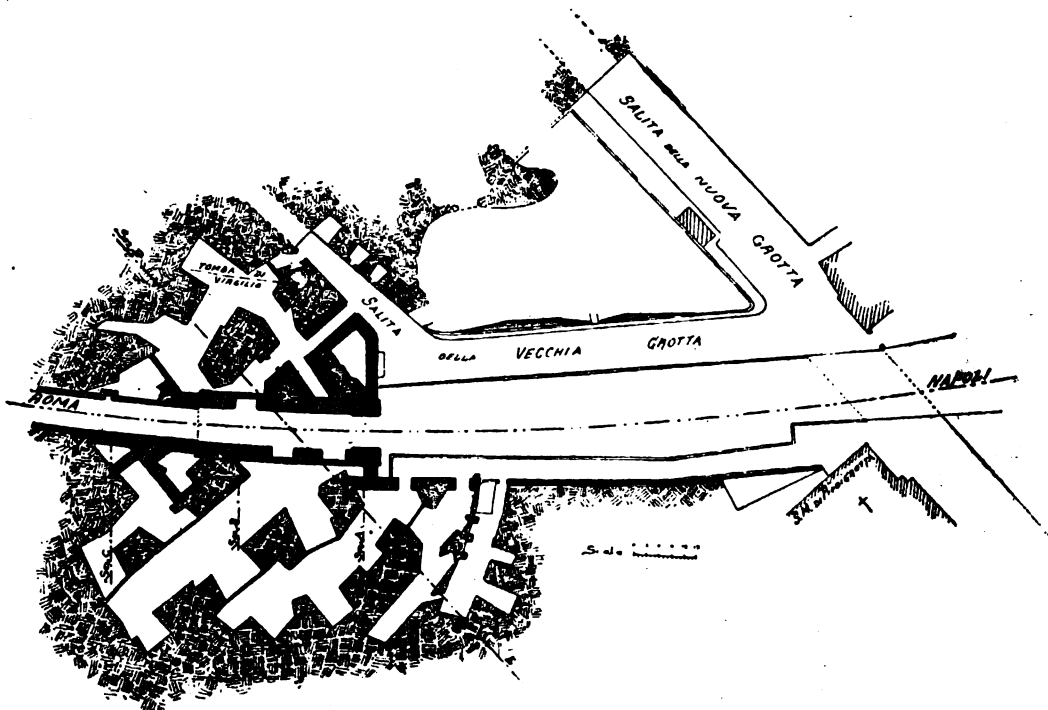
Tratto della Galleria di Posillipo attraverso le cave a Piedigrotta: Opere di consolidamento.
